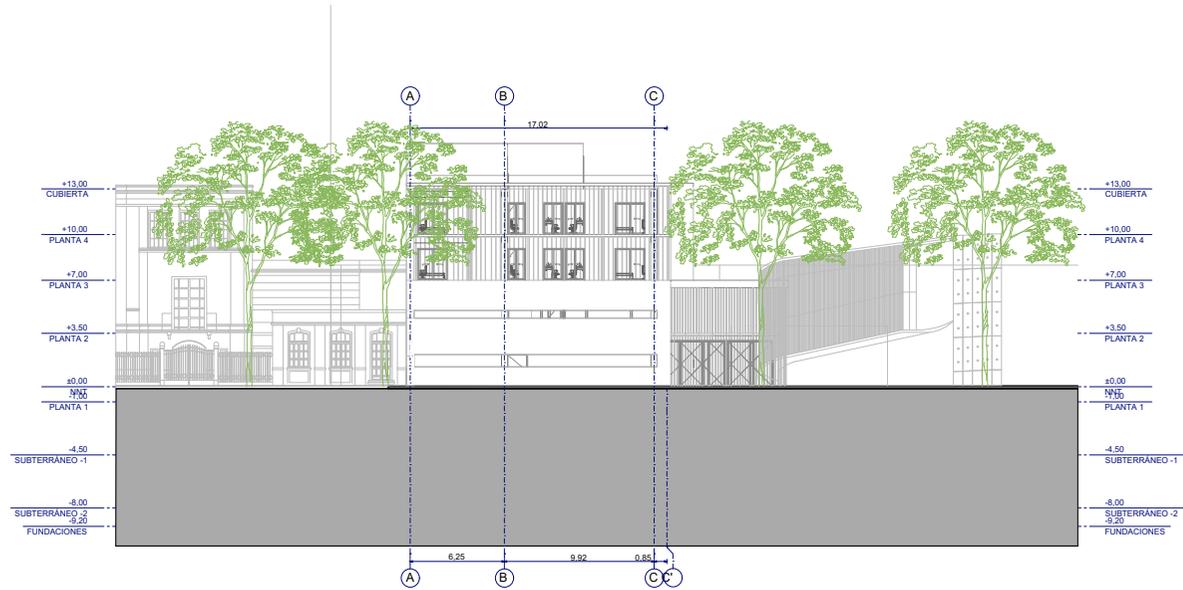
Elevación Oriente y Norte. Fuente: Elaboración propia
